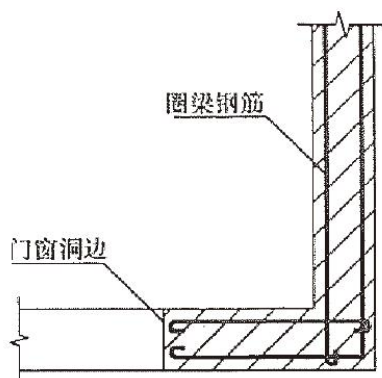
配筋砖圈梁在洞口边、转角处钢筋搭接做法
